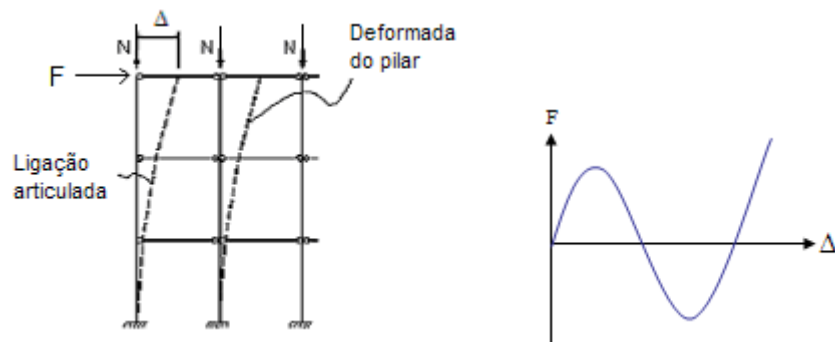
Comportamento geometricamente não linear caracterizado a partir de um pórtico plano.
